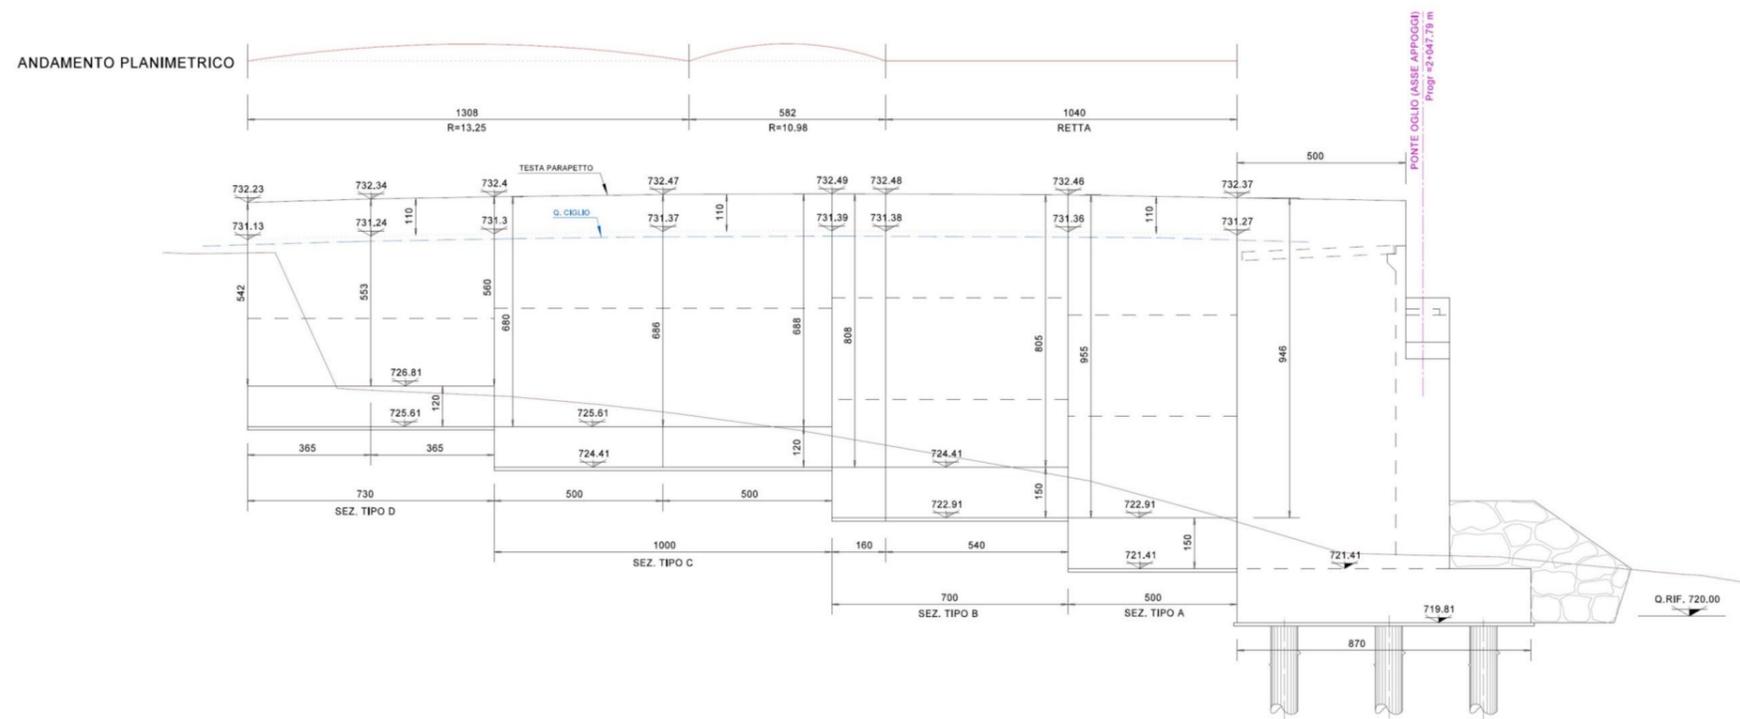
Ponte sul Fiume Oglio – Muri andatori – Prospetto sviluppato Muro 2
